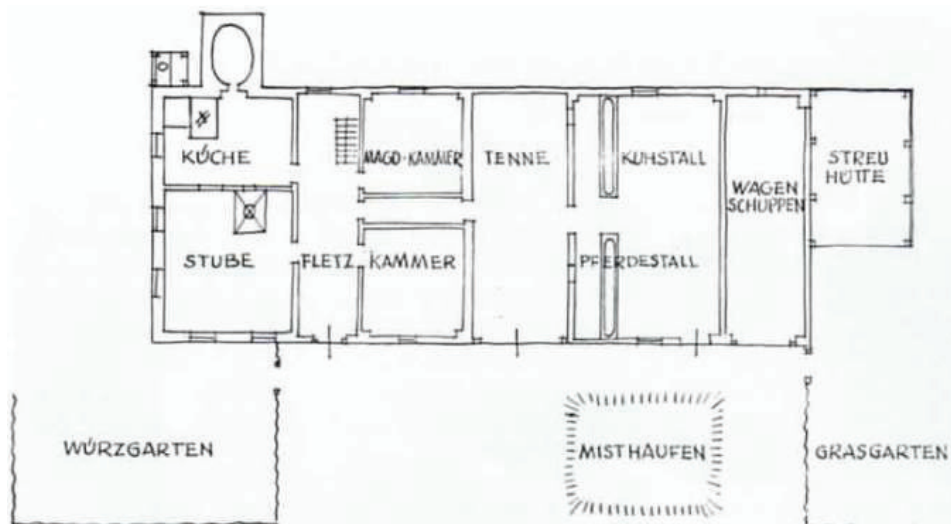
Grundriss eines Mittertennbaues
